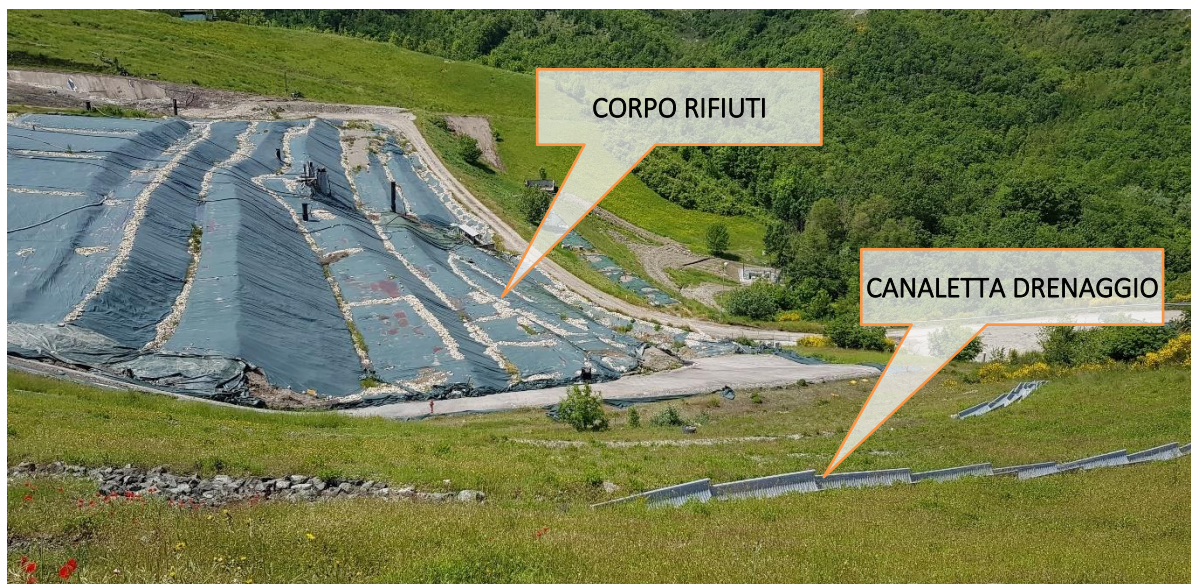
FOTO 02 - Vista da Est della porzione di valle del corpo rifiuti – in primo piano un tratto del sistema di intercettazione e drenaggio delle acque meteoriche
